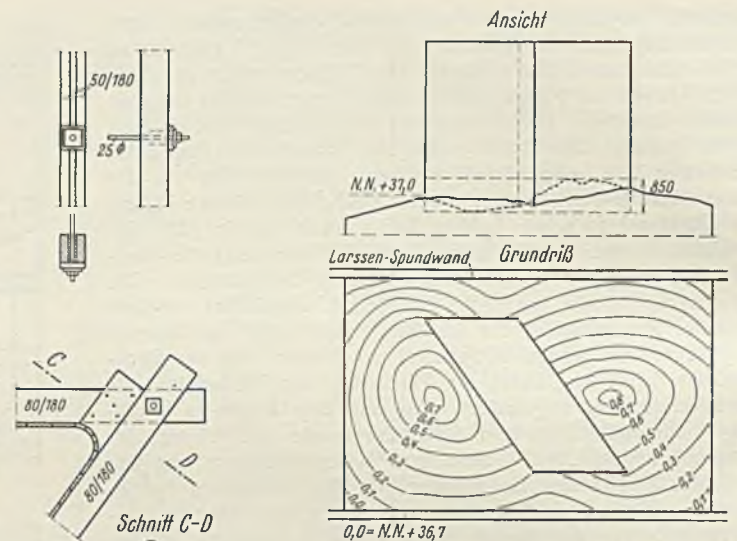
Abgepeelte Grundfläche für eine Pfeilerschalung. M. 1 : 200.
